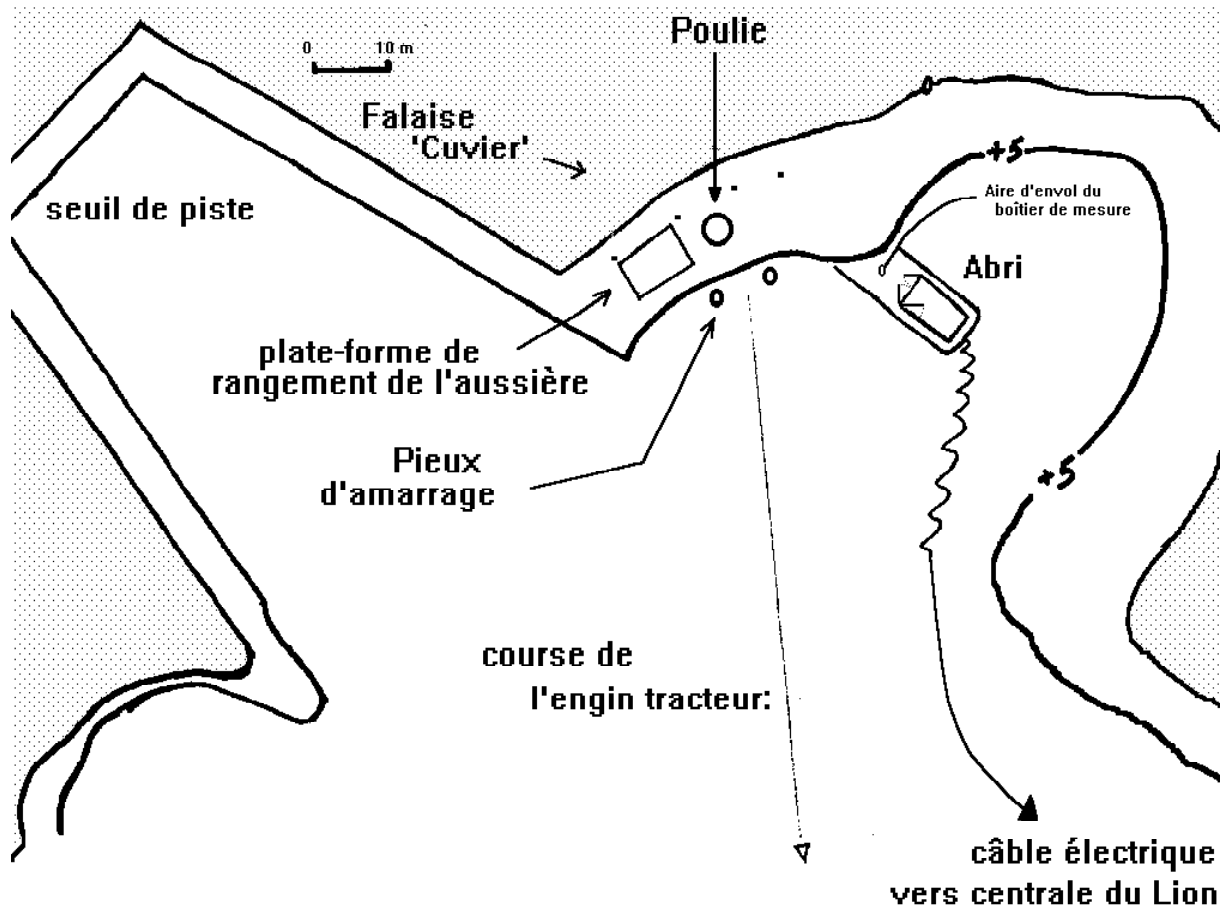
Falaise d'impact Cuvier, plan des installations.
